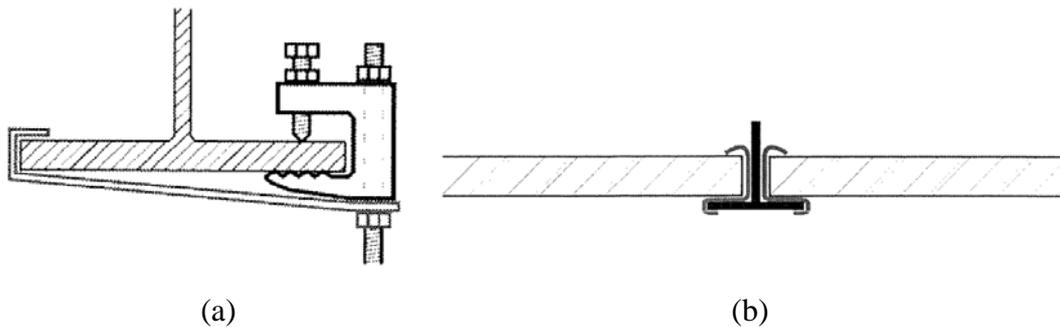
Fixations comprenant une protection parasismique: a) fixation de la tige de suspension, b) fixation des panneaux de plafond (Marxer et al. 2003).
